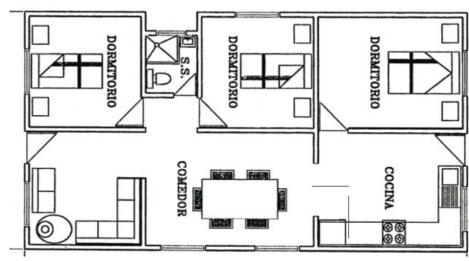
Planta Arquitectónica "Casas Baratas" 1942 Fuente: Planos, Gastón Bartorelli.
